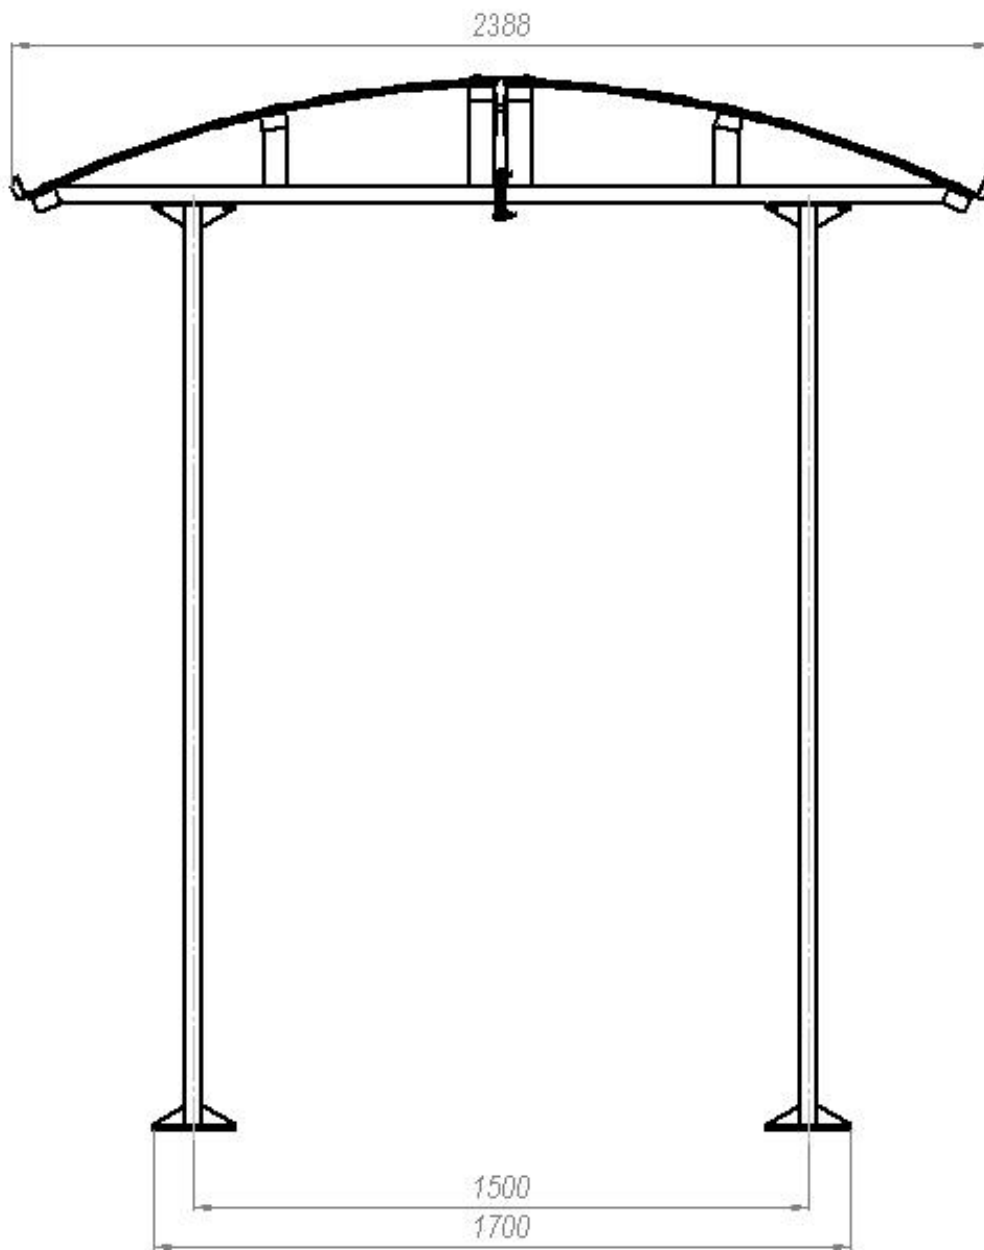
(а) – Габаритные размеры крыши (вид с торца)
